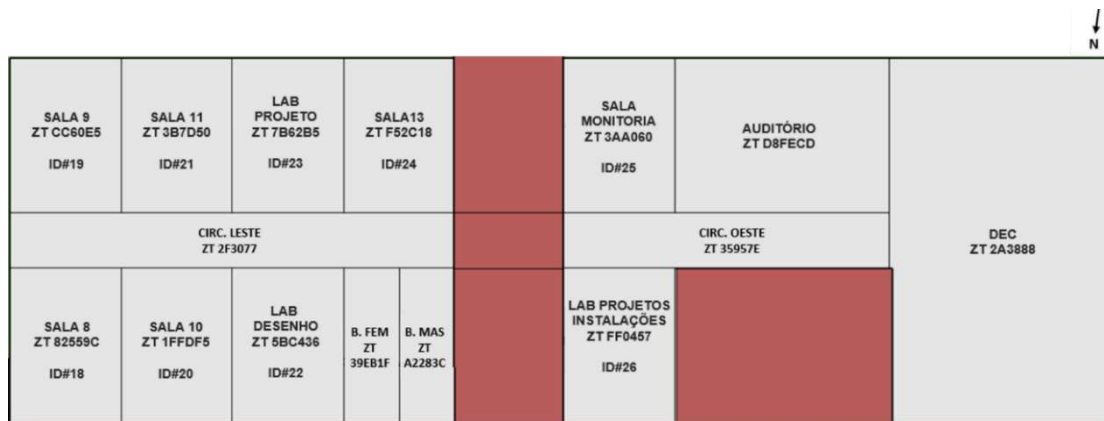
ZT 2º pavimento prédio 12. Fonte: Elaboração própria, 2019.
